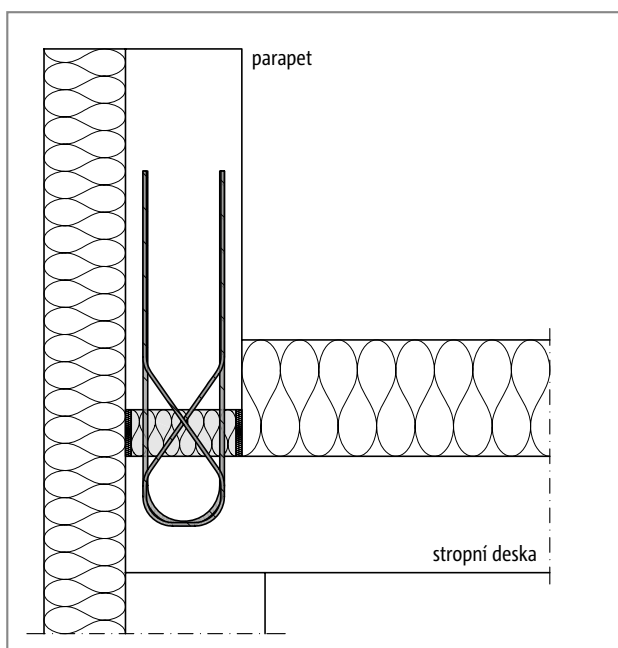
Schöck Isokorb® T typ AP - vodorovné zabudování: Půdorys, předsazení parapetu resp. atiky
